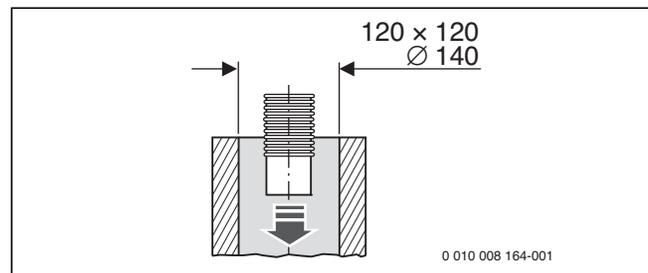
Mindestmaße des Schachtquerschnitts für die Montage der flexiblen Abgasleitung bis Kesselgröße 50 kW (Maße in mm)
